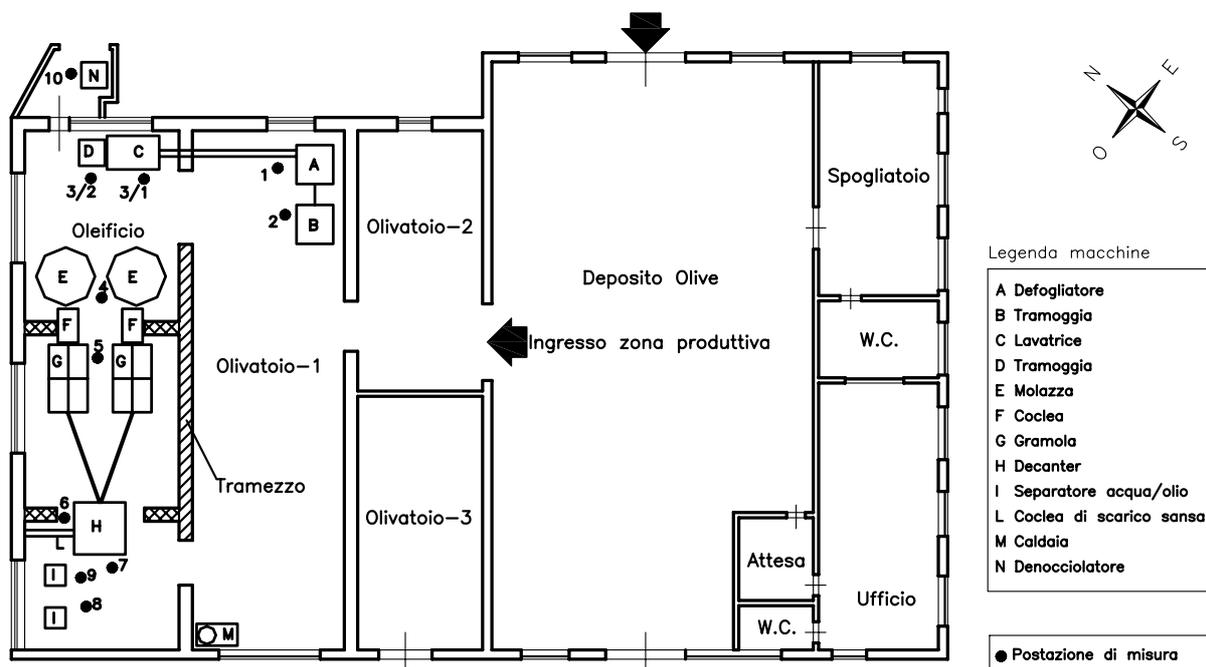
Planimetria frantoio con indicazione dei punti di posizionamento degli strumenti di misura.
